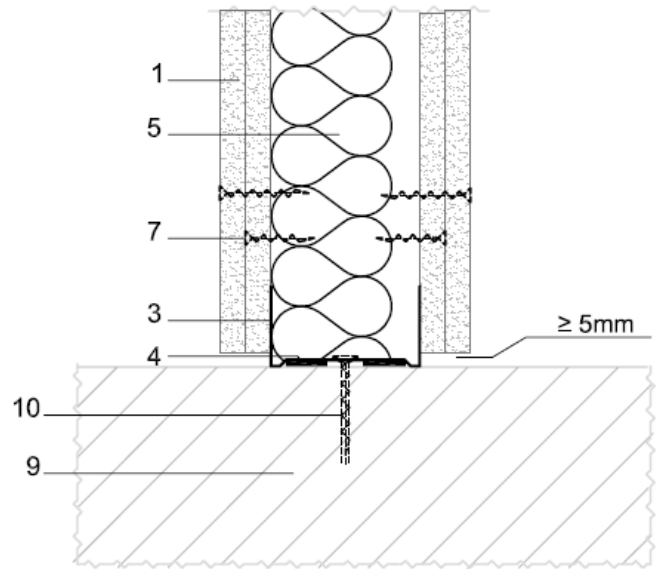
Sección horizontal de un tabique con subestructura doble y panelado doble.
